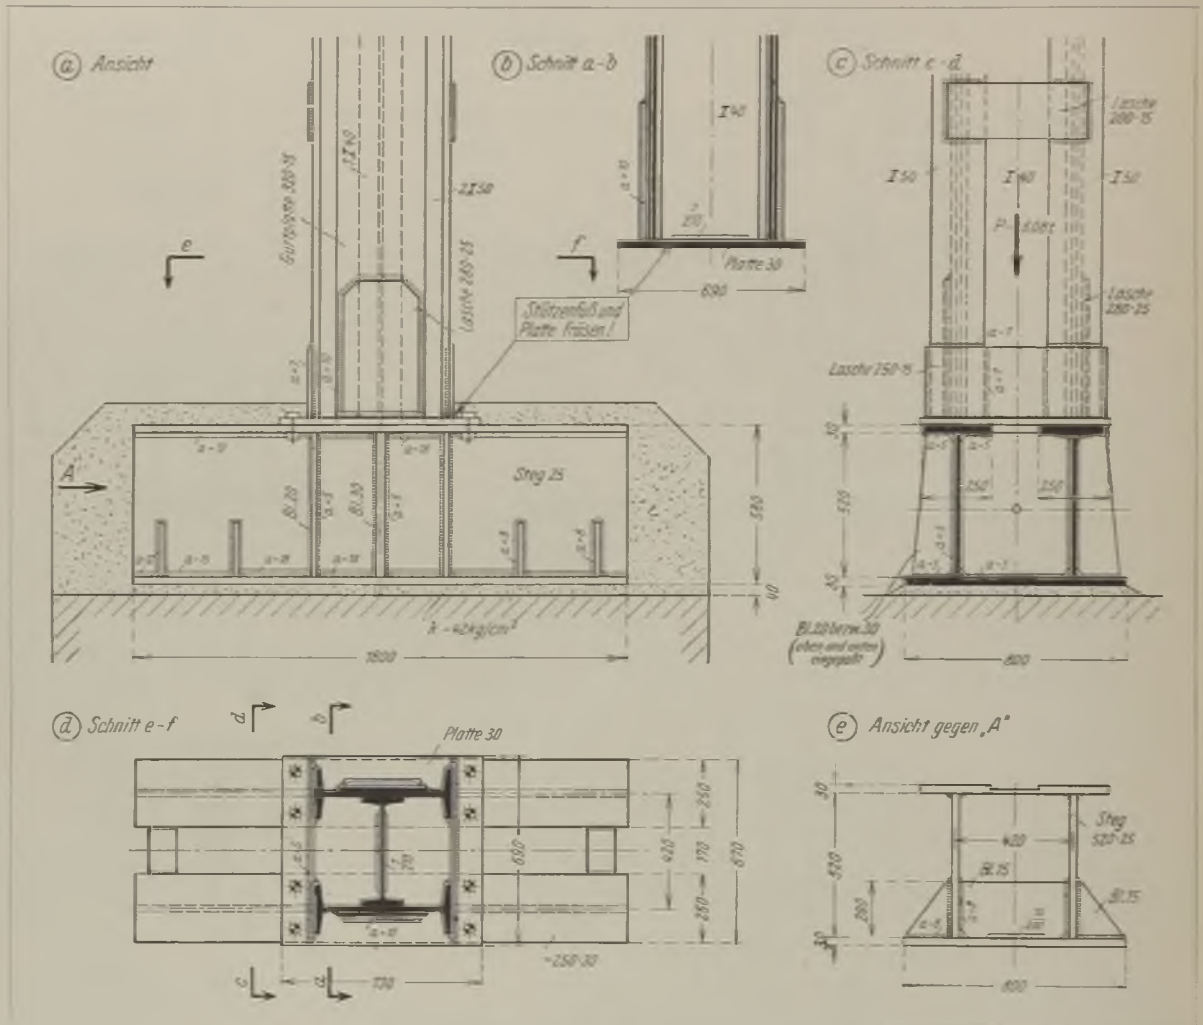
Fuß einer Geschosbaustütze mit einem geschweißten Rosträger.
